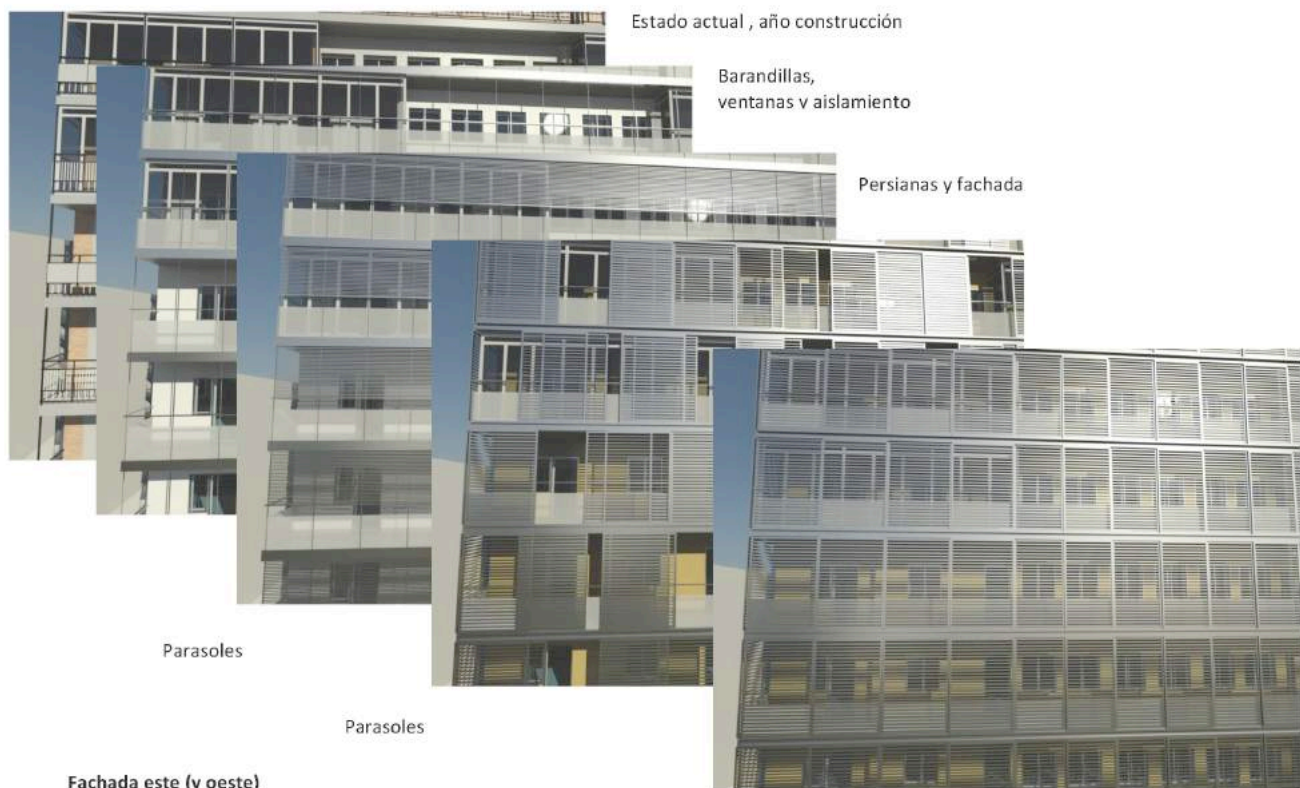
Propuestas de intervención arquitectónica en las fachadas este y oeste.
